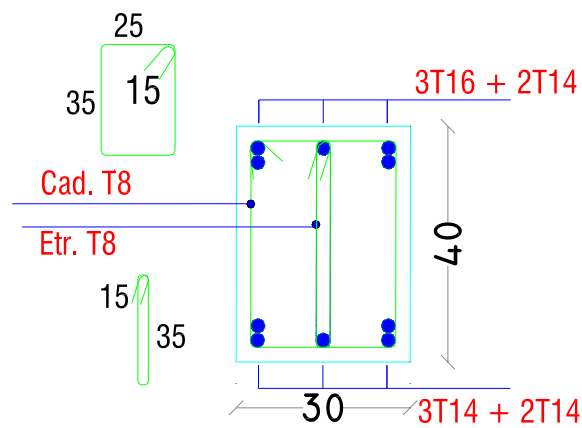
Ferrailage des poutres principales pour Etage 4,5 et 6.
